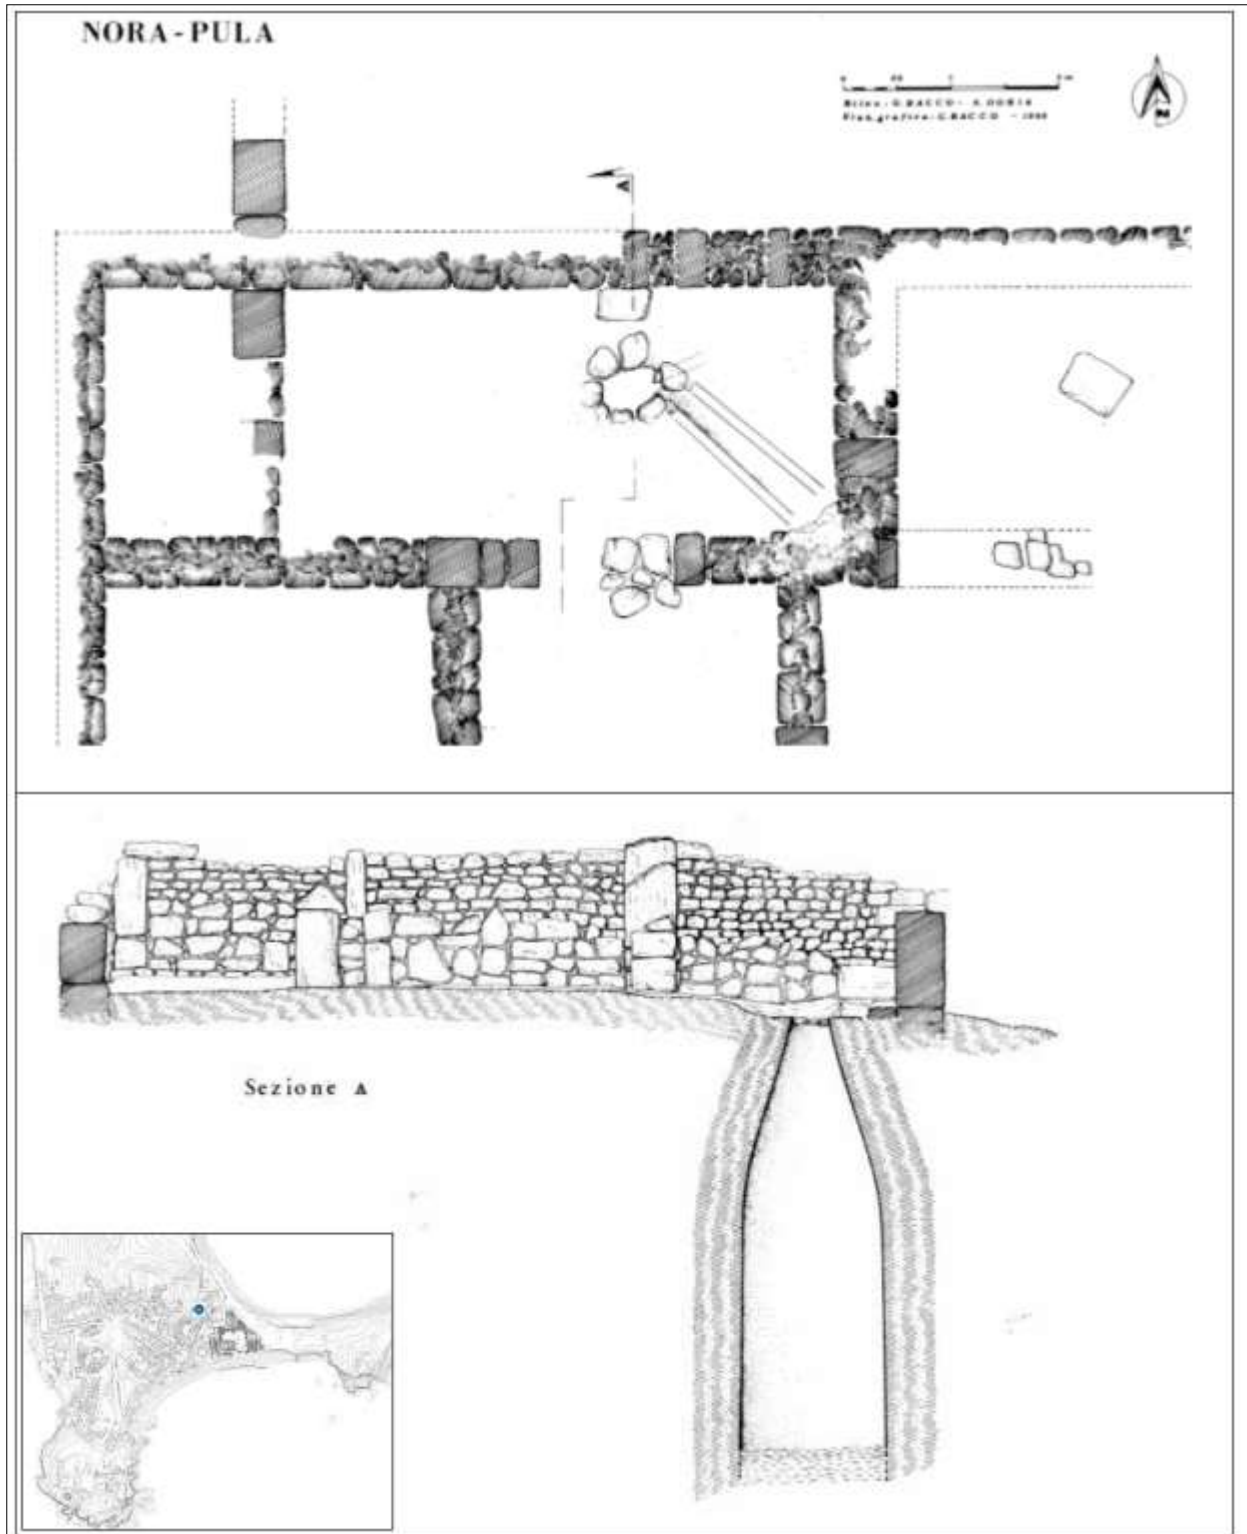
Pianta e sezione del pozzo 17 (rielaborazione da BARRECA 1986, pp. 190-191).
